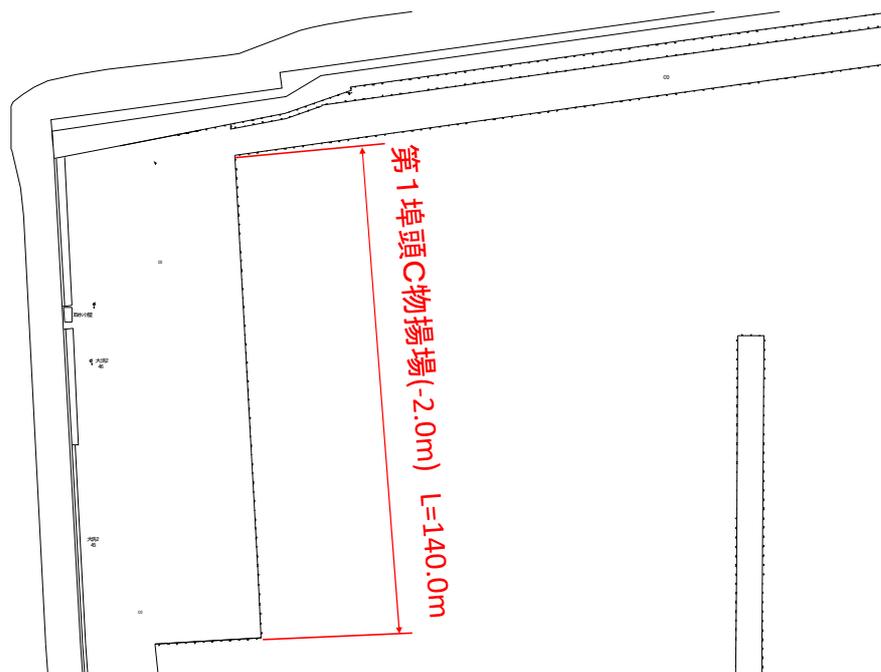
256 No.24 大洗港区_第1埠頭C岸壁 (-5.0m) (中央地区) の平面図 (被災前)
